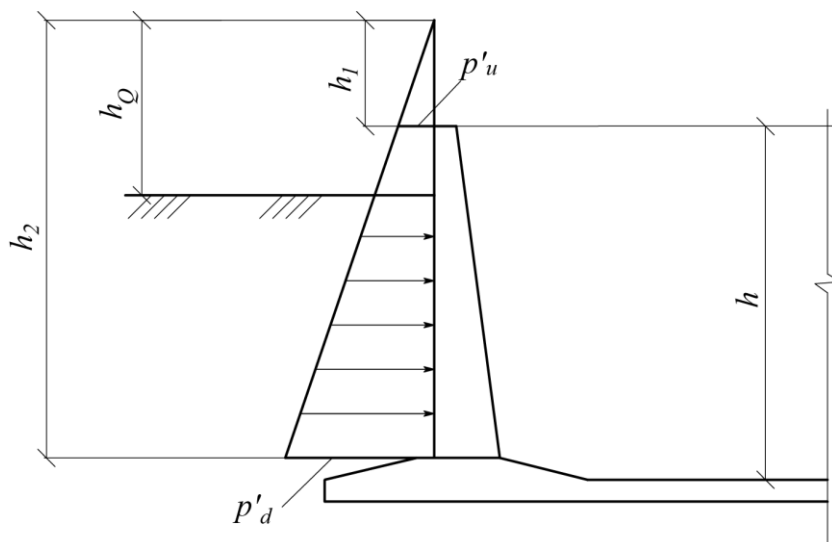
К расчету давления грунта на стенку резервуара
